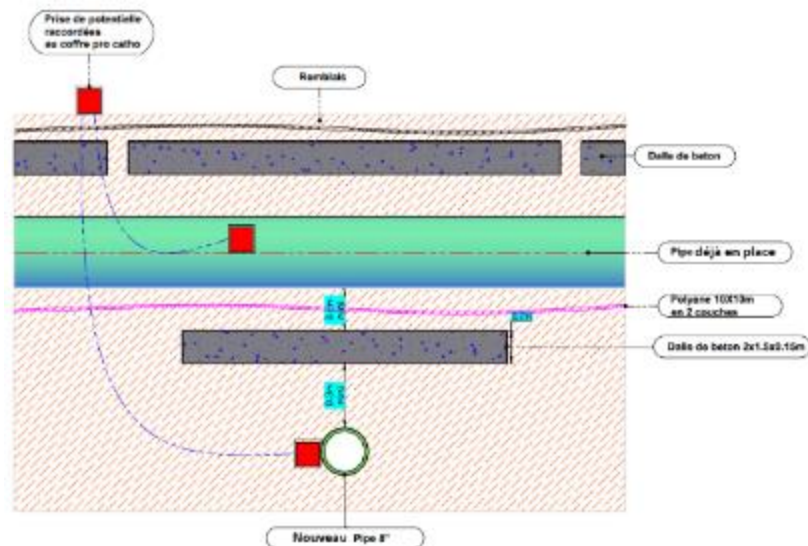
Schéma typique d'agencement d'un crossing de pipe rencontré lors de la pose.
